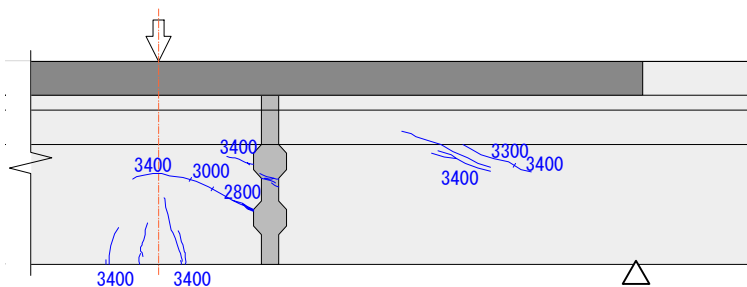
ひび割れ図：拡大 (Bライン側)
